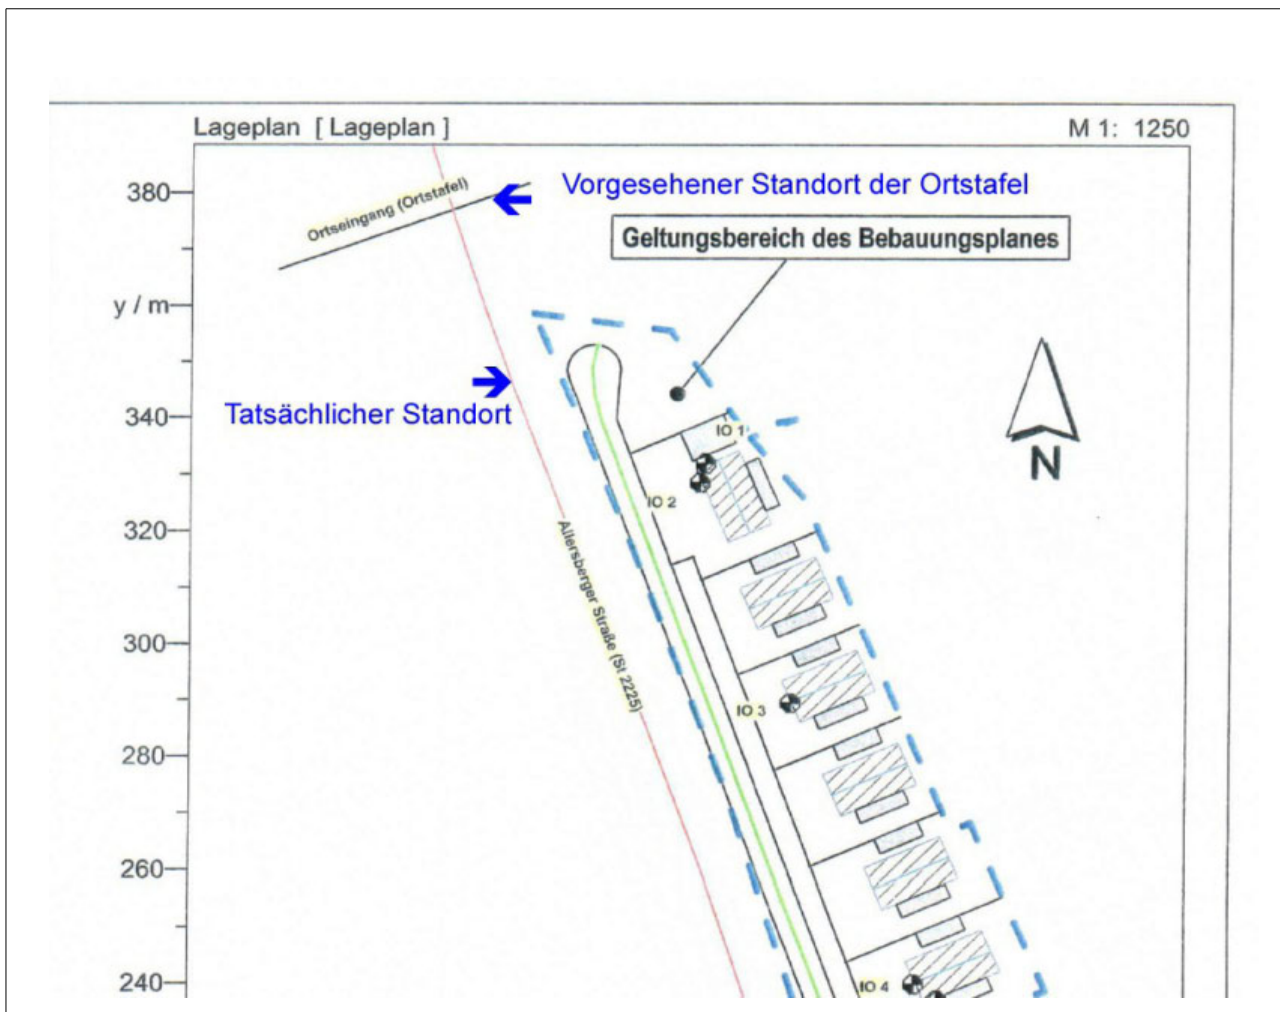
Lageplan des Bebauungsplanes mit Angabe des Ortseingangsschildes
